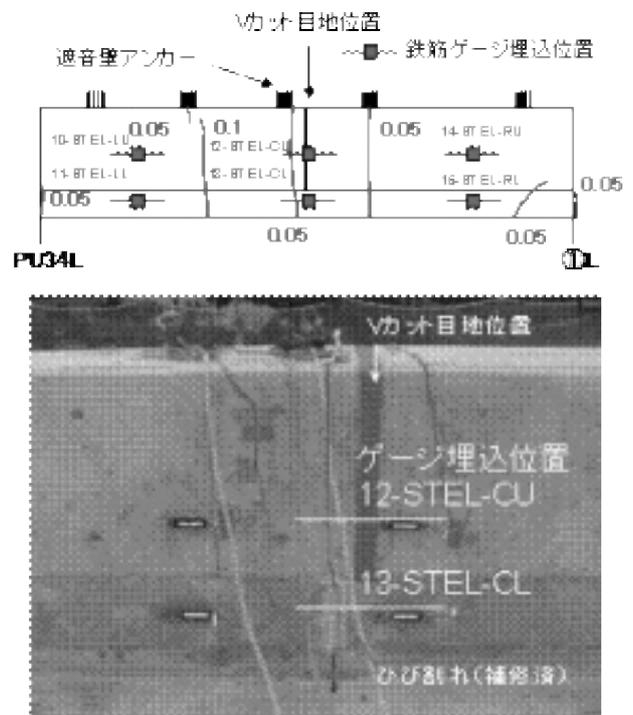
壁高欄鉄筋ゲージ埋込位置 (脱枠後ひび割れ状況)
